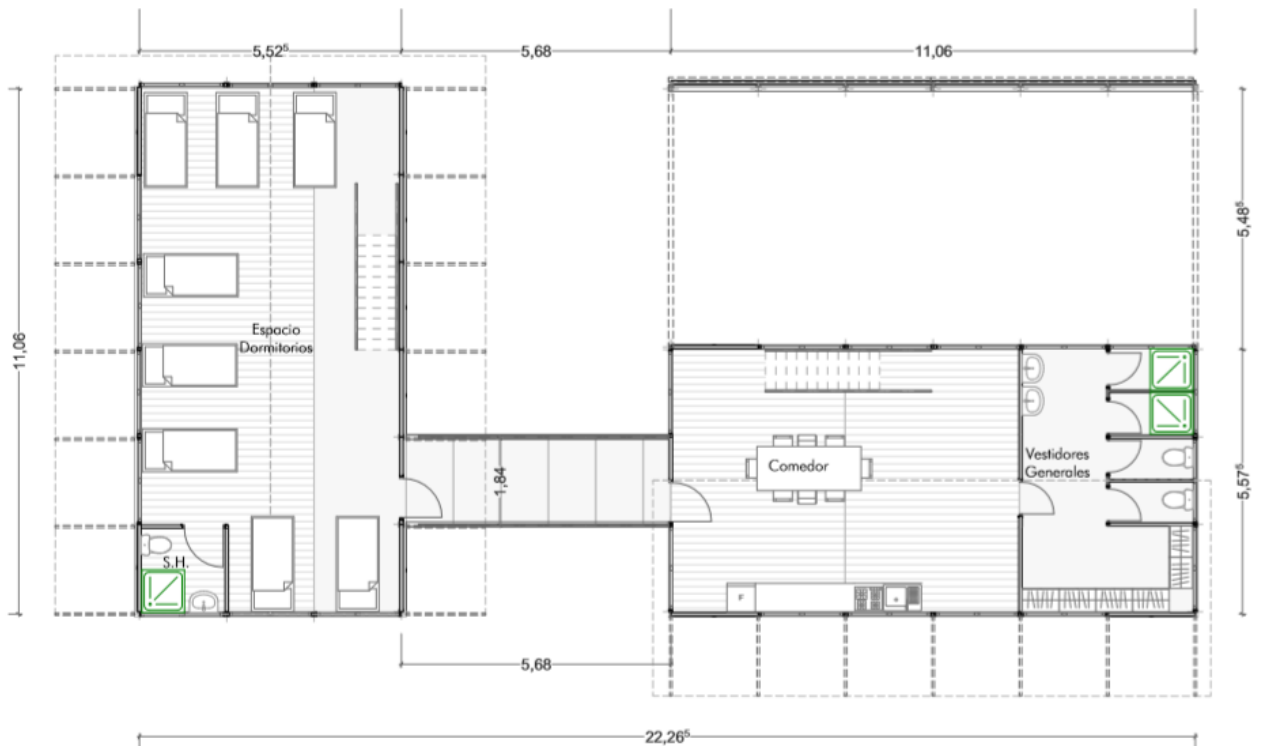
Plano arquitectónico de la planta alta de la estación de cuerpo de bomberos
